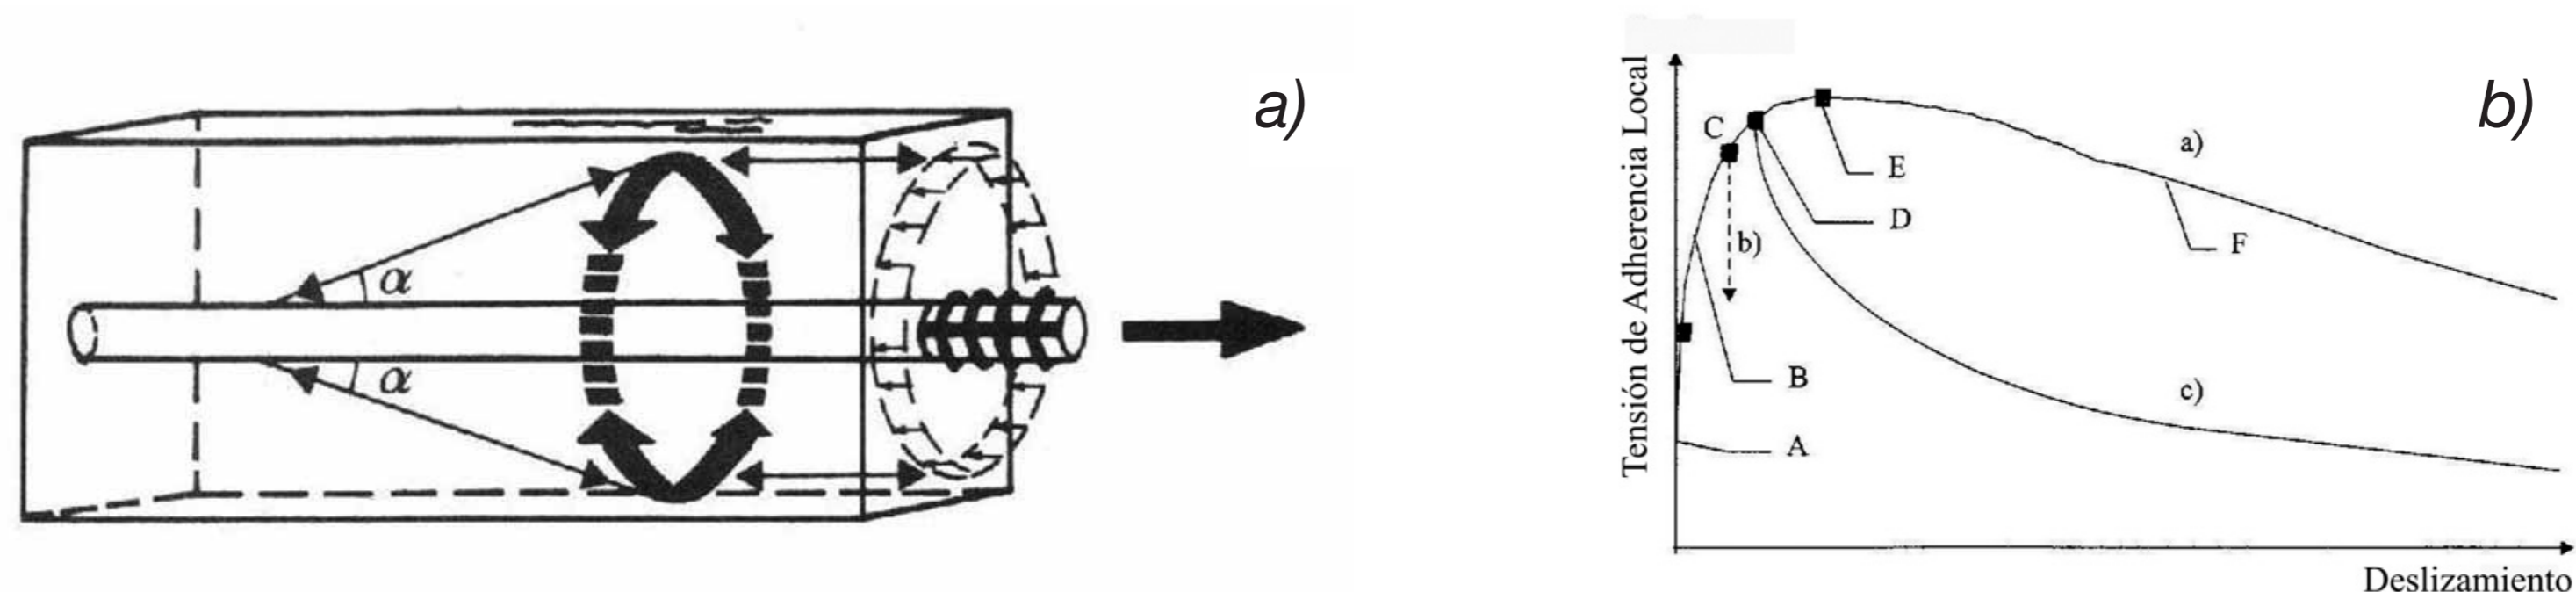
a) Formación de anillo de tracción en el hormigón equilibrando las fuerzas de adherencia (Tepfers 1973), b) Relación tensión de adherencia local / deslizamiento (Magnusson 2000).
